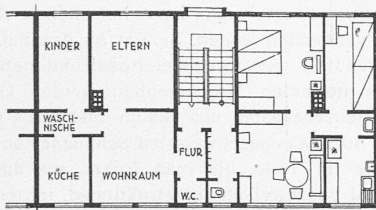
Grundriss des Holzskelett-Baublocks. Masstab 1 : 300.
